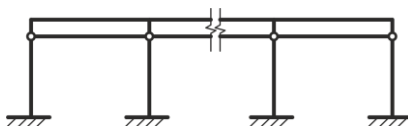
Расчетная схема поперечного сечения проектируемого здания
